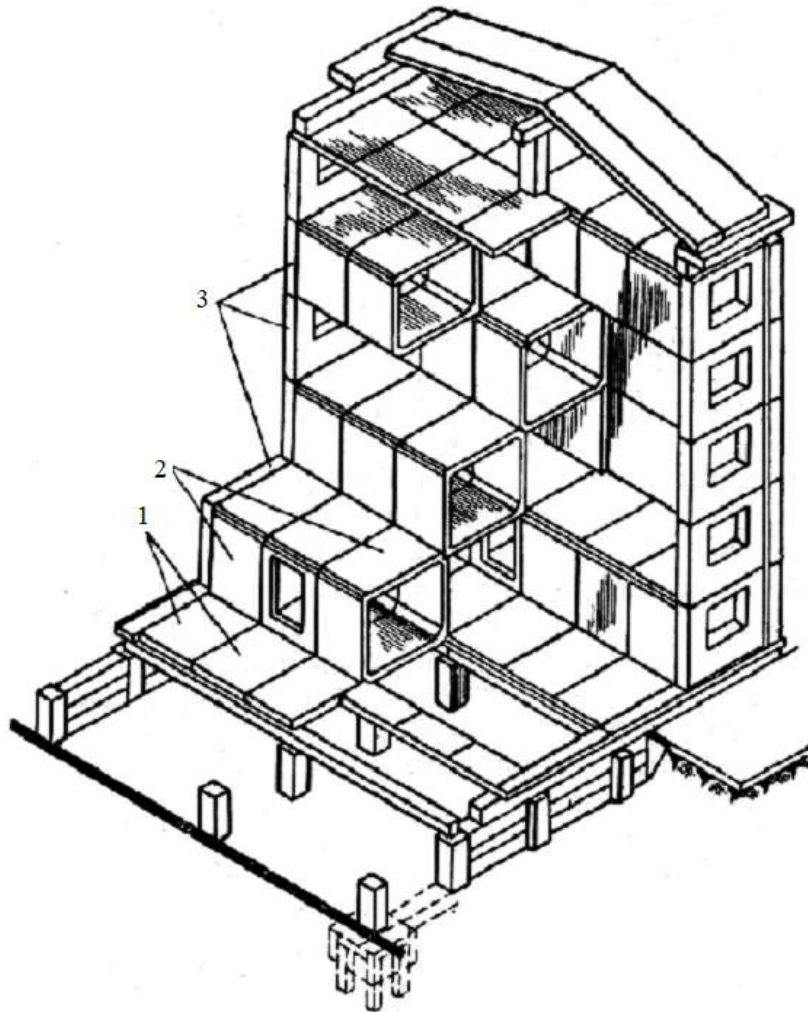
Блоково-панельна конструктивна система із сотоблоків: 1 – панелі перекриття; 2 – сотоблоки; 3 – панелі зовнішньої стіни
